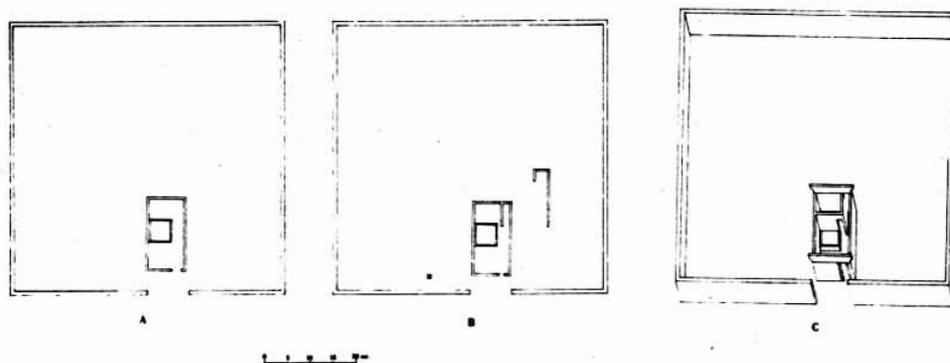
A. Tempio di Sid Addir Babai (fase di V sec. a.C.). Planimetria. B-C. Tempio di Sid Addir Babai (fase di III sec. a. C.). Planimetria assonometrica.
